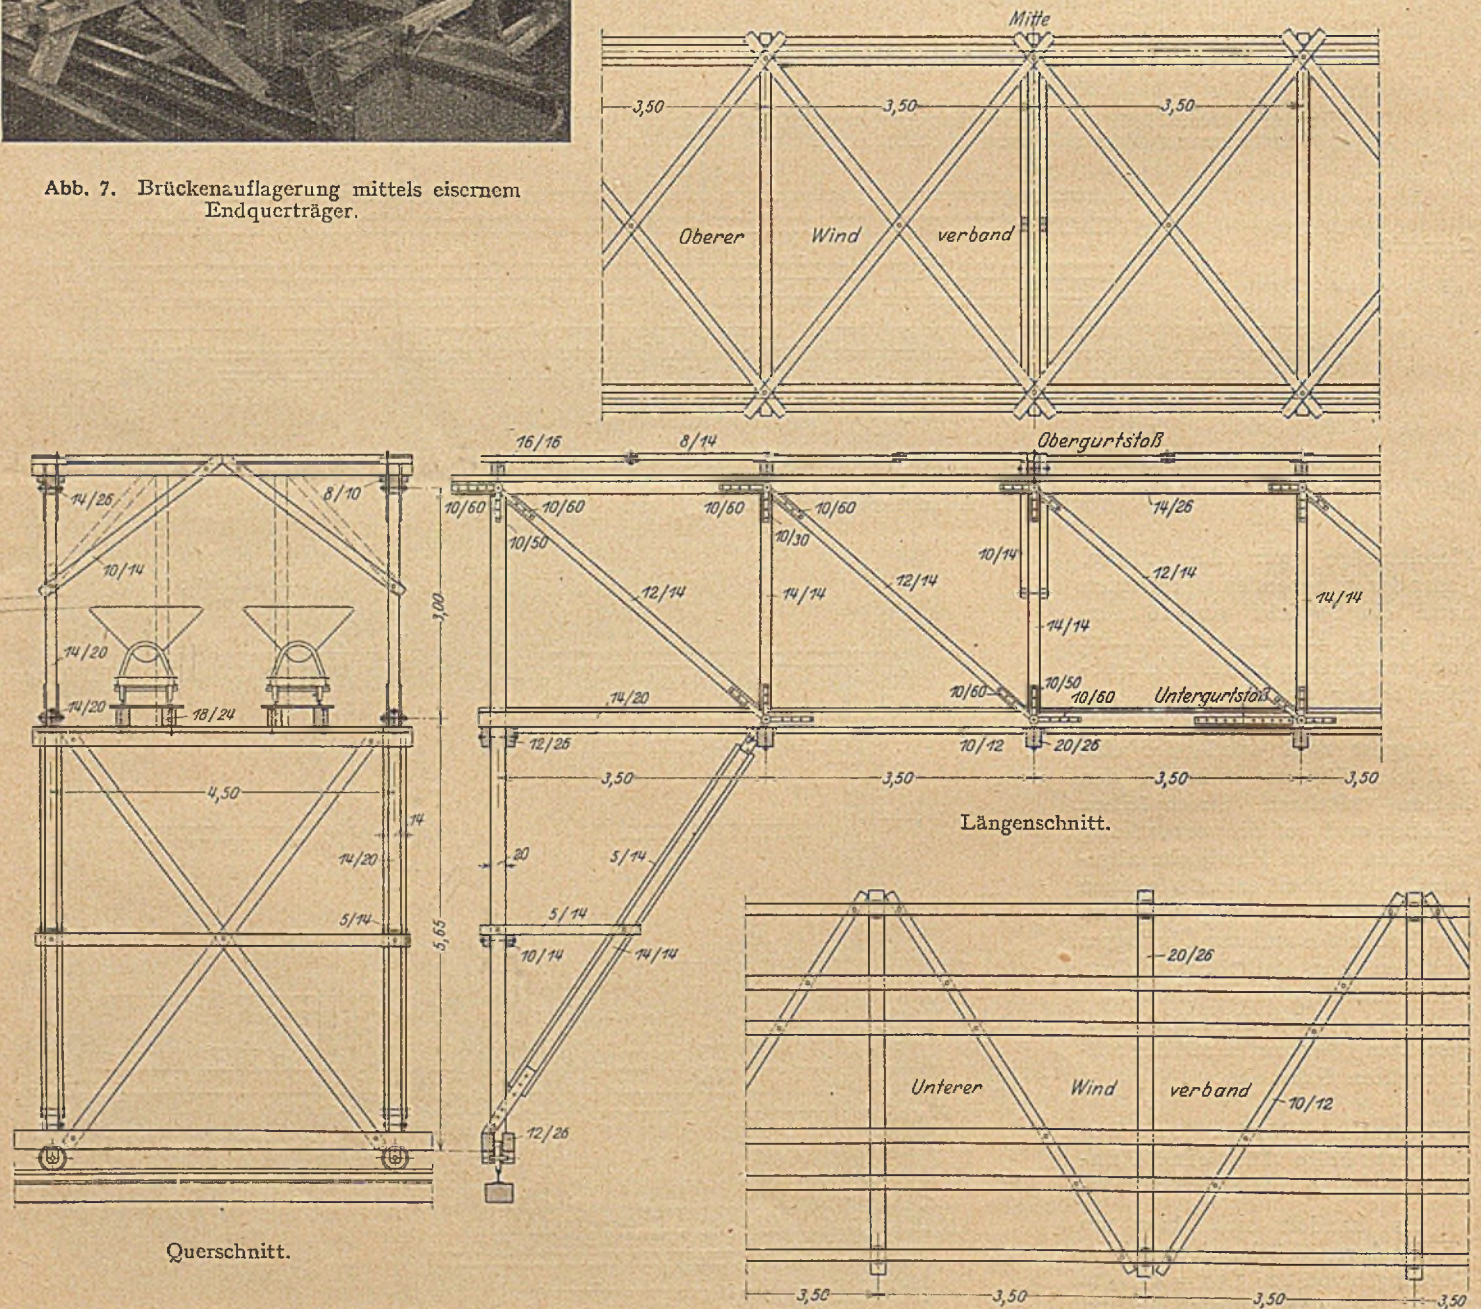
Betonierbrücke zur Ausführung eines Löschtroges in Essen.
